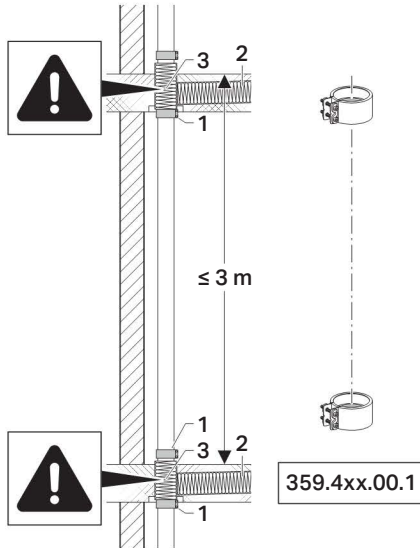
Falleitung mit einbetonierten Anschlussleitungen ohne Dehnelement
